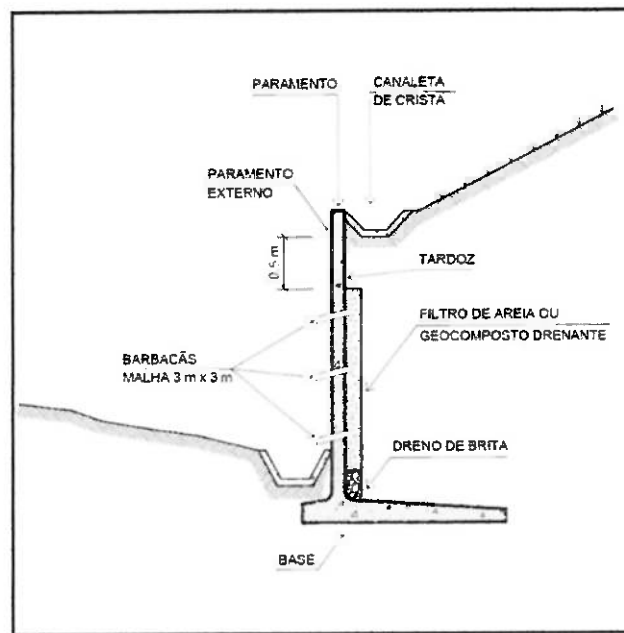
Esquema genérico de um muro de arrimo de flexão com fundação direta
